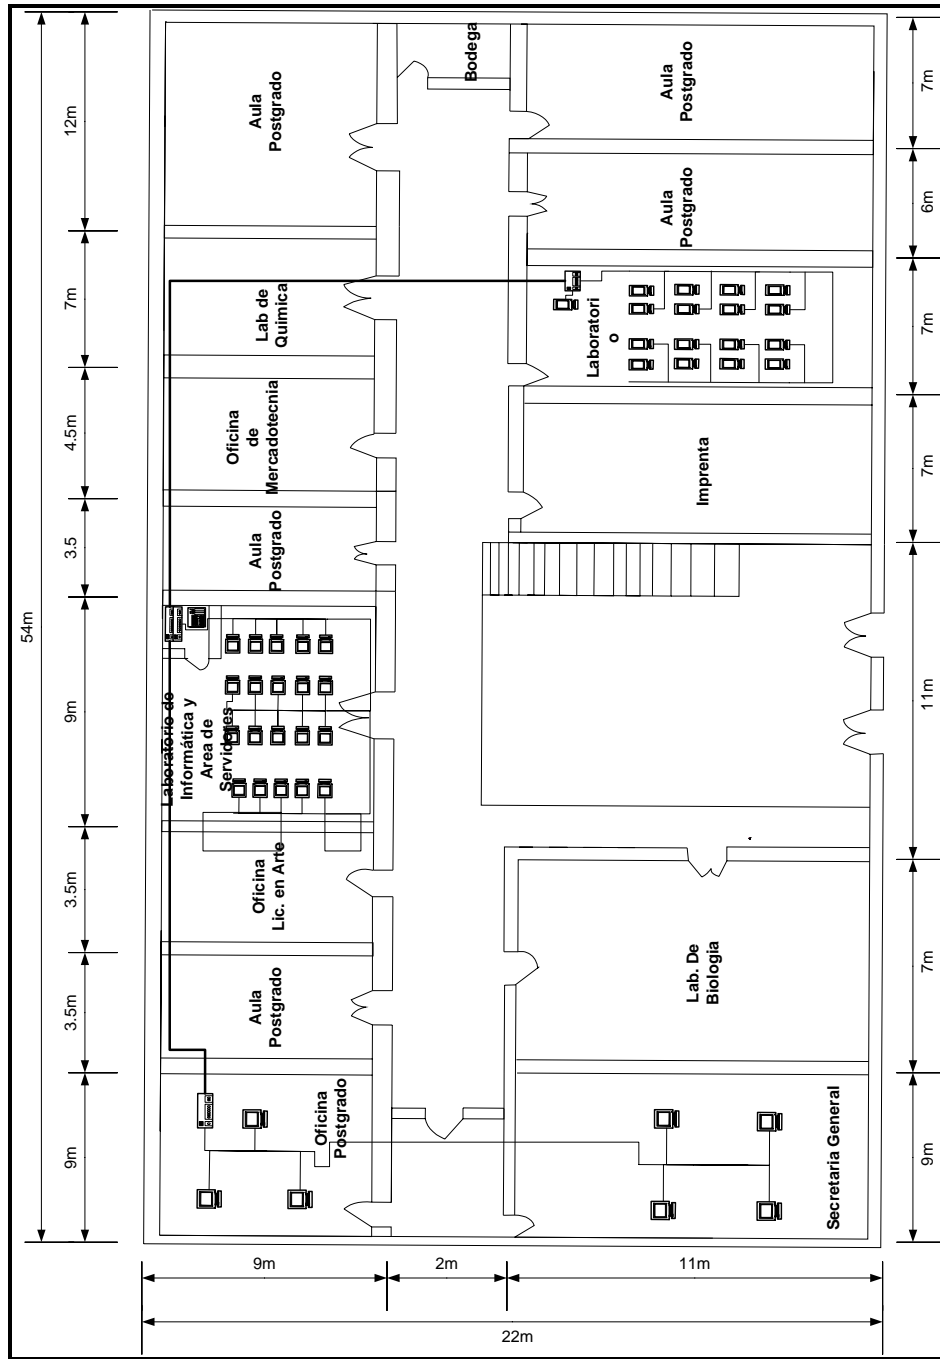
Plano Digital Planta Baja – Edificio Principal
